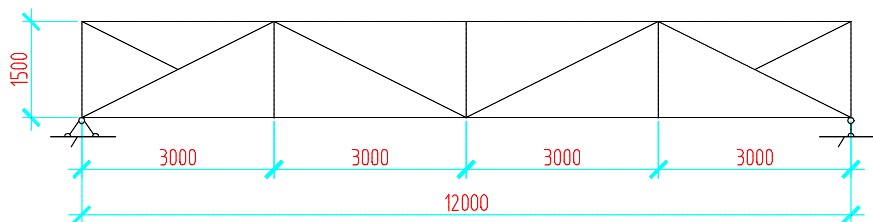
Расчетная схема стропильной фермы _ вариант 4
